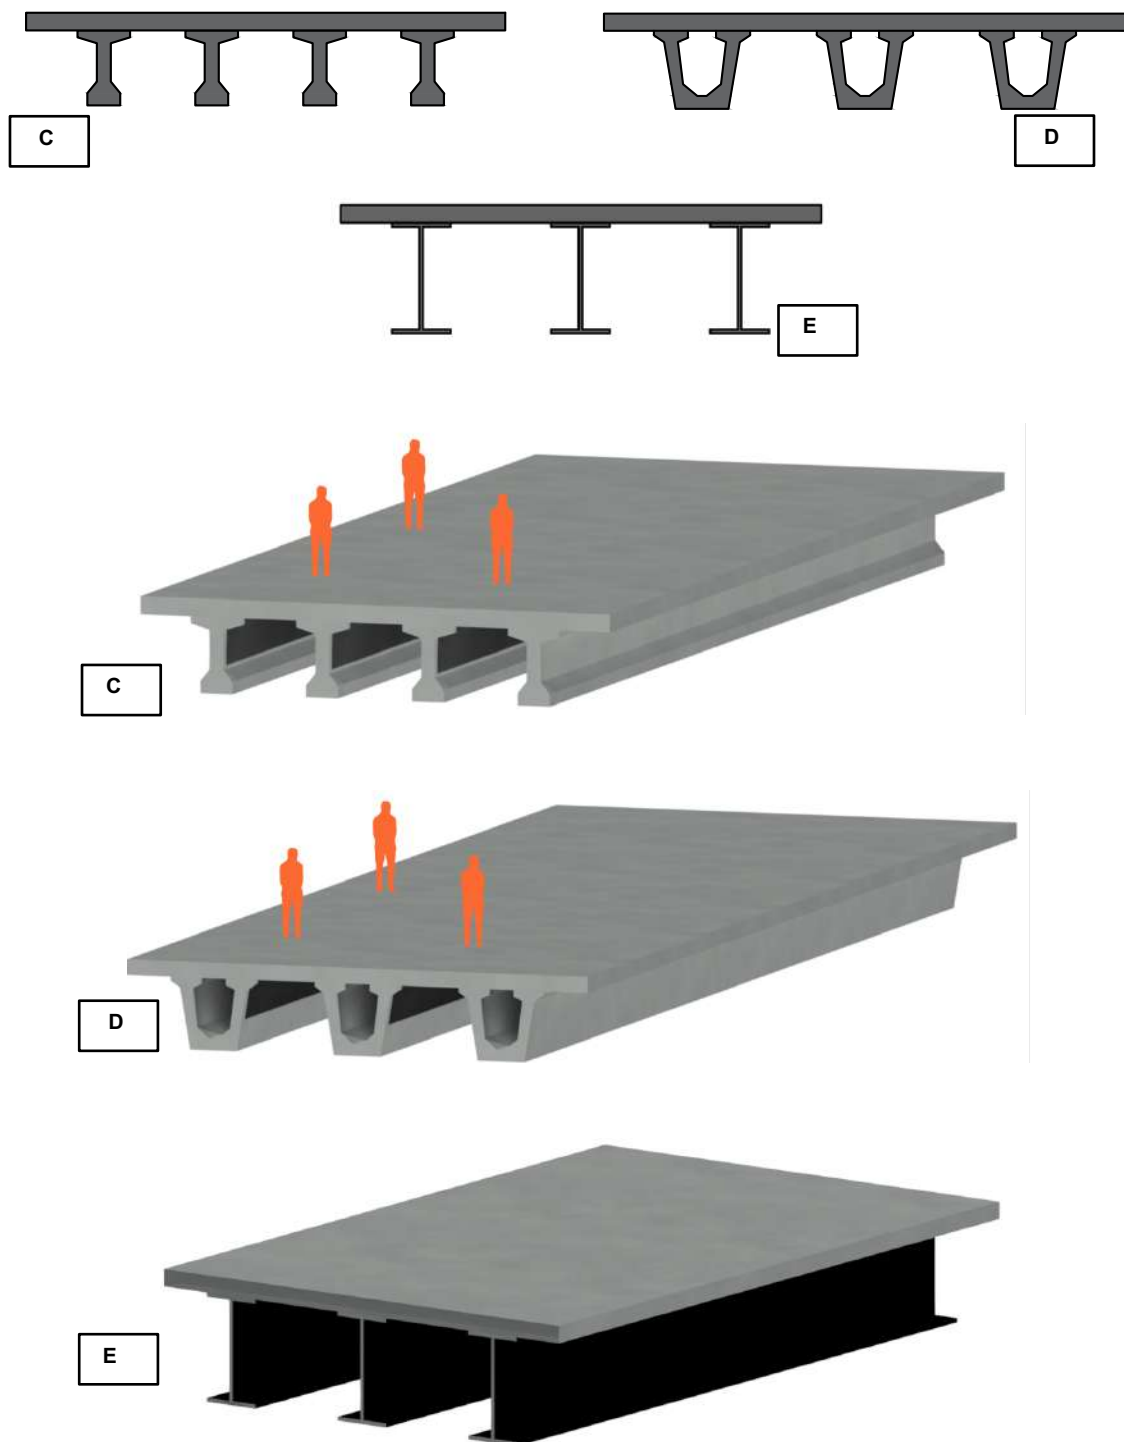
C. Longarinas tipo “I” pré-moldadas. D. Longarinas “calha” pré-moldada. E. Longarinas metálicas tipo “I” shape. Fonte: autoral
